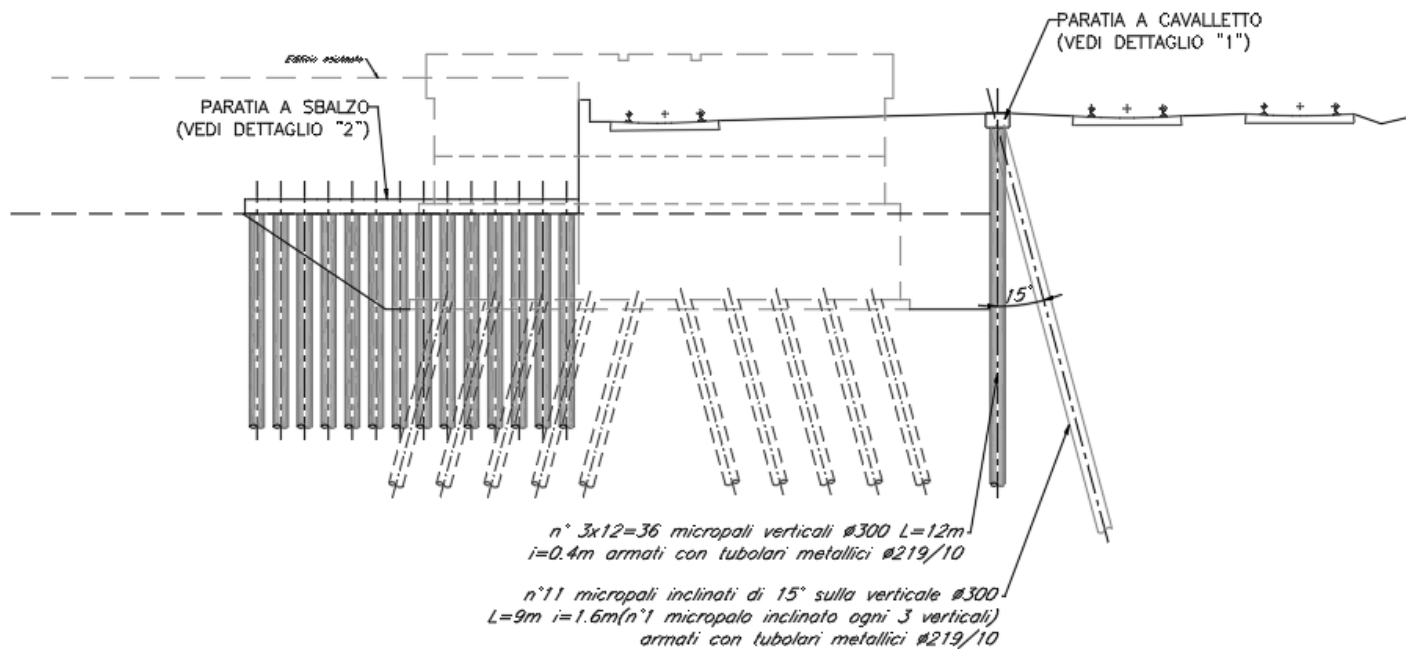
Sezione Opere Provvisionali Spalla B
